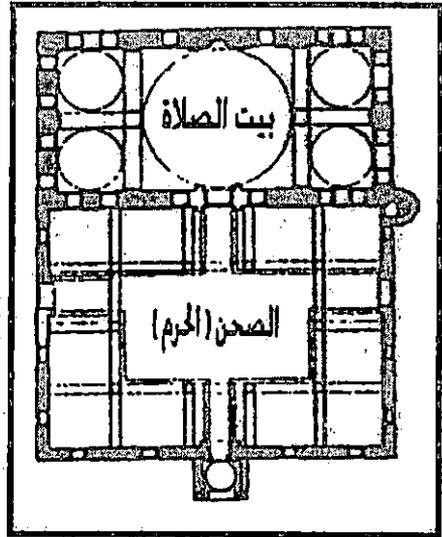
مسقط أفقي لخان أغدير على
